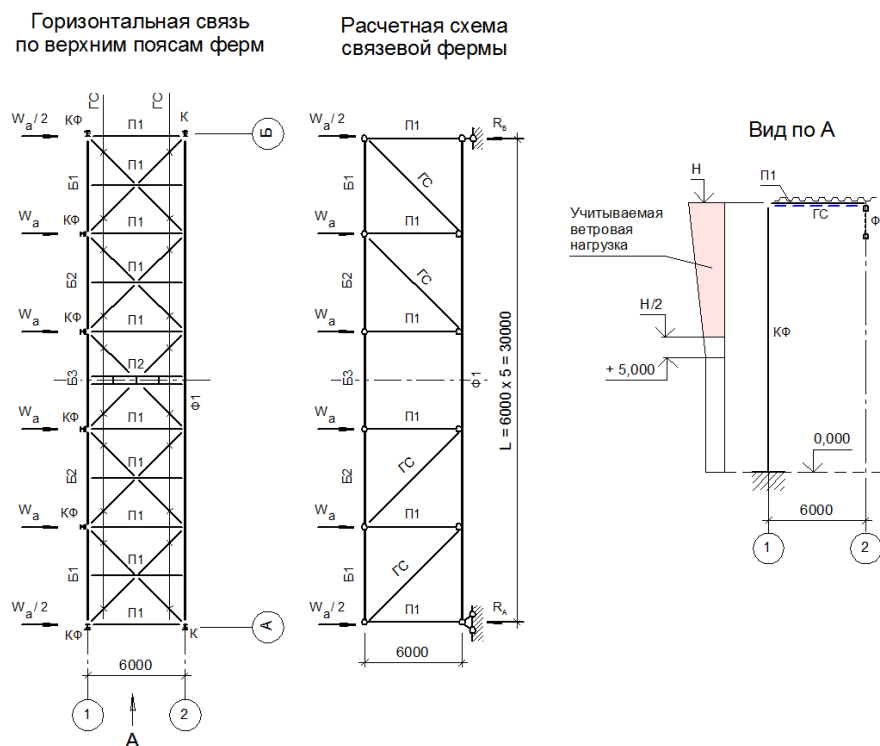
К расчету горизонтальной связи по верхним поясам ферм.
